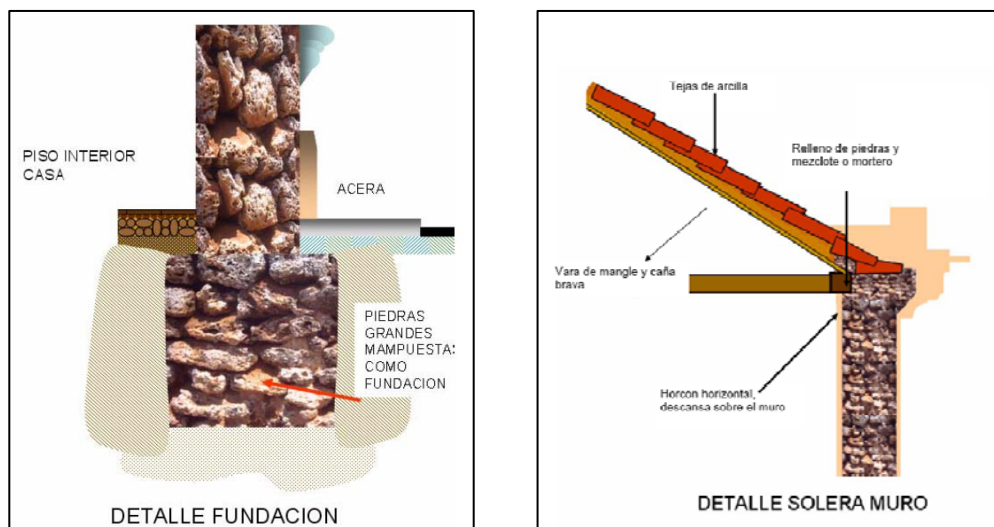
a) Detalle de la cimentación. b) Sección de la mampostería del cerramiento.
